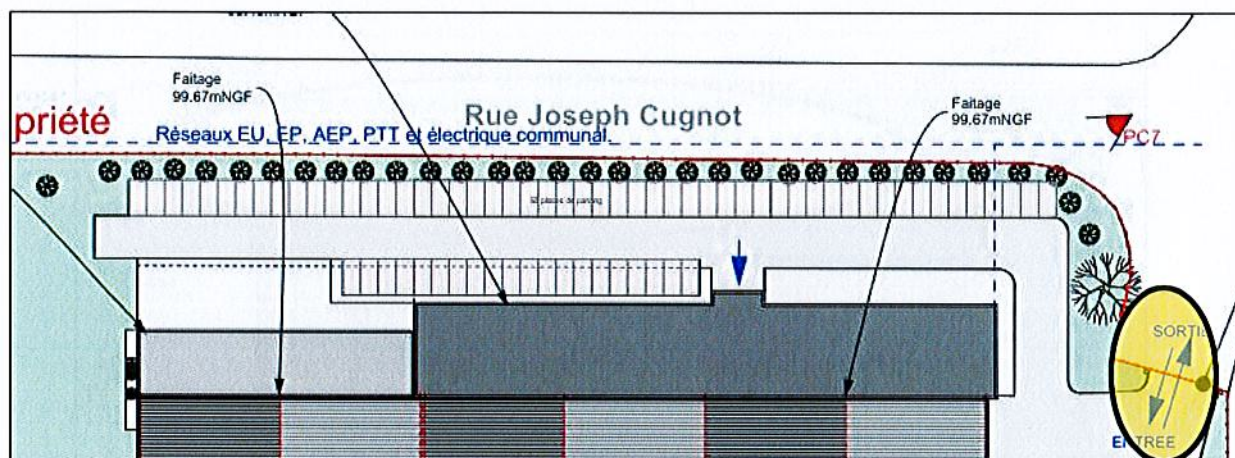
Plan de masse indiquant l'entrée du site actuel
